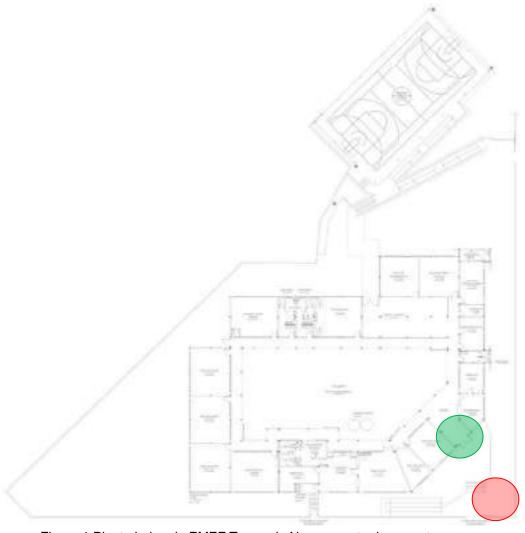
Planta baixa da EMEF Tancredo Neves, ponto de encontro.
